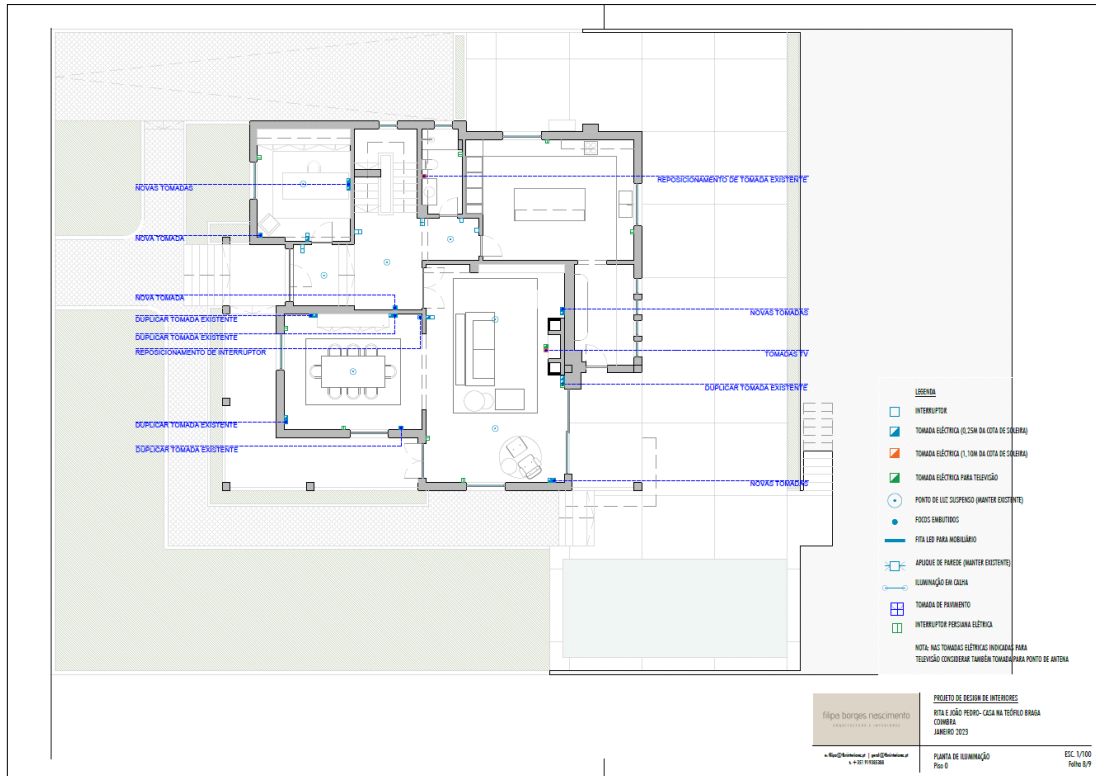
Planta de iluminação (Fonte: Autora, 2022)
